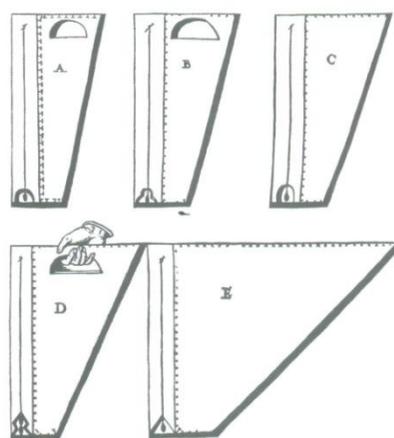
Instrumentos para definir o talude de uma muralha, do tratado de Castrioto e Maggi (1585).
